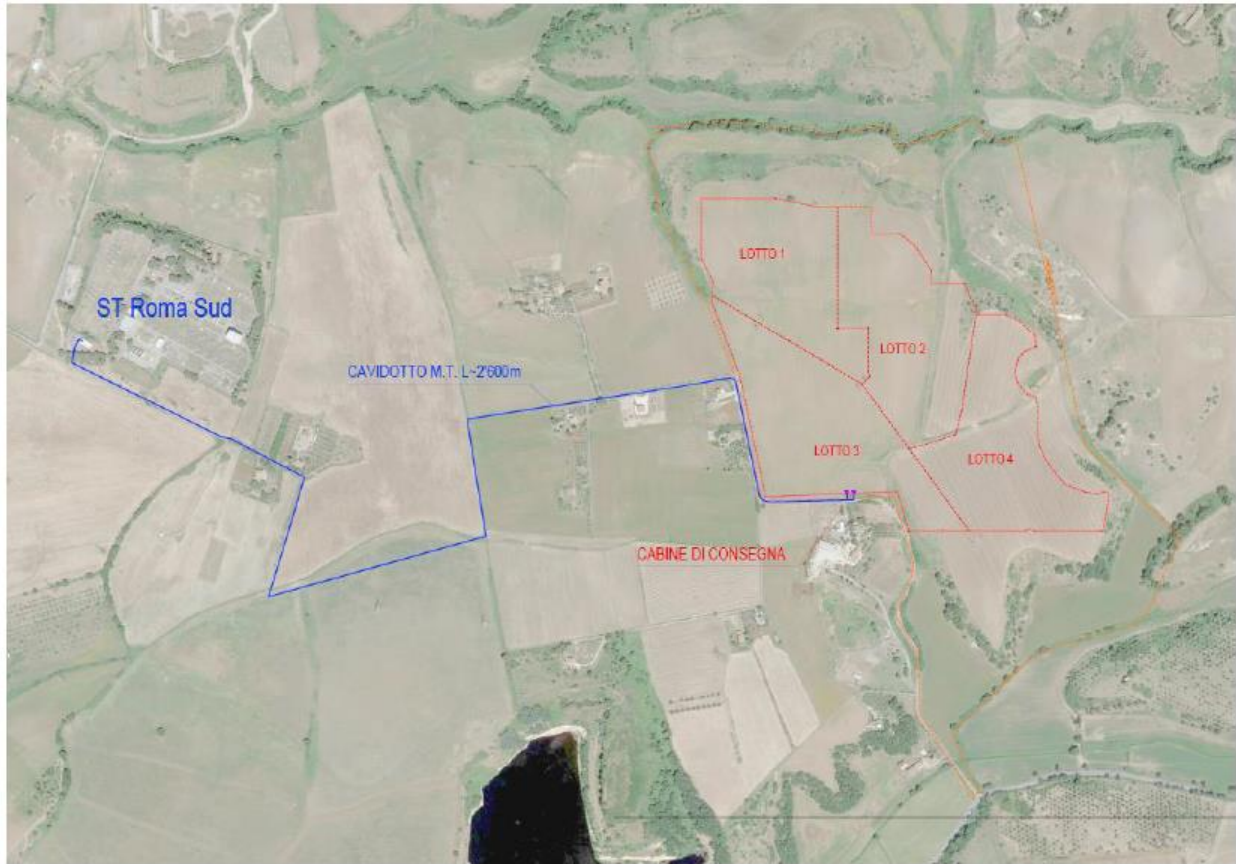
Inquadramento delle opere di connessione su ortofoto
